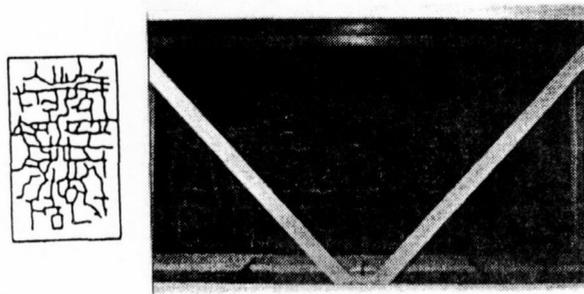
亀甲状のひび割れ<sup>31)</sup>
